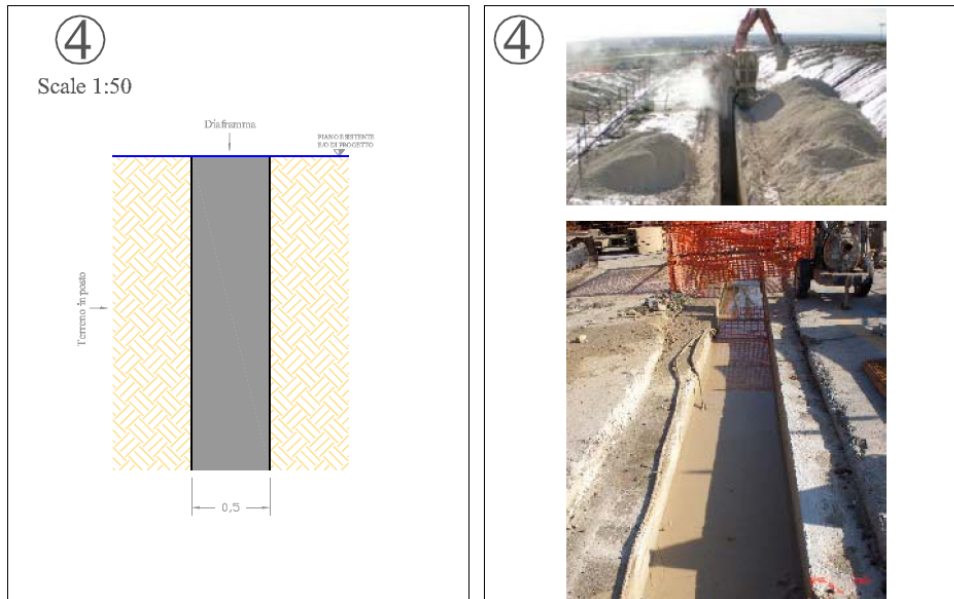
Particolare del sistema di isolamento laterale del sito contaminato.
